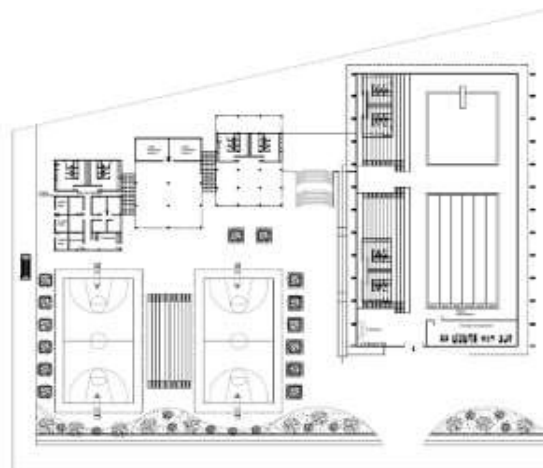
Planta baja conjunto de Centro Polideportivo (2018)
